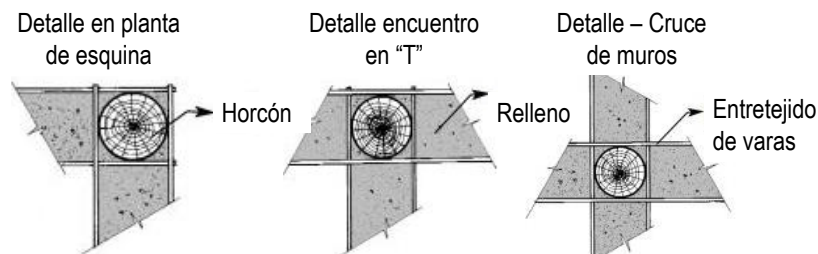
Obtenida de (Carazas Aedo & Rivero Olmos, 2002). Detalle en planta de los muros.
